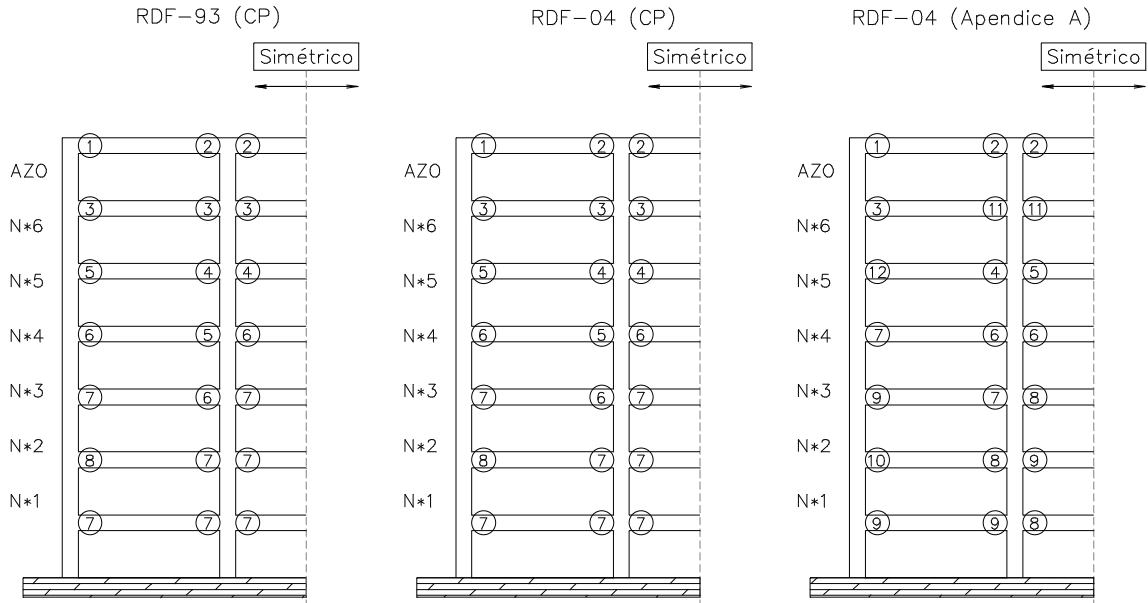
Ubicación de los tipos de armados de vigas del eje 2, estructuras de 7 niveles, diseños en zona II (RDF-93 y RDF-04)
